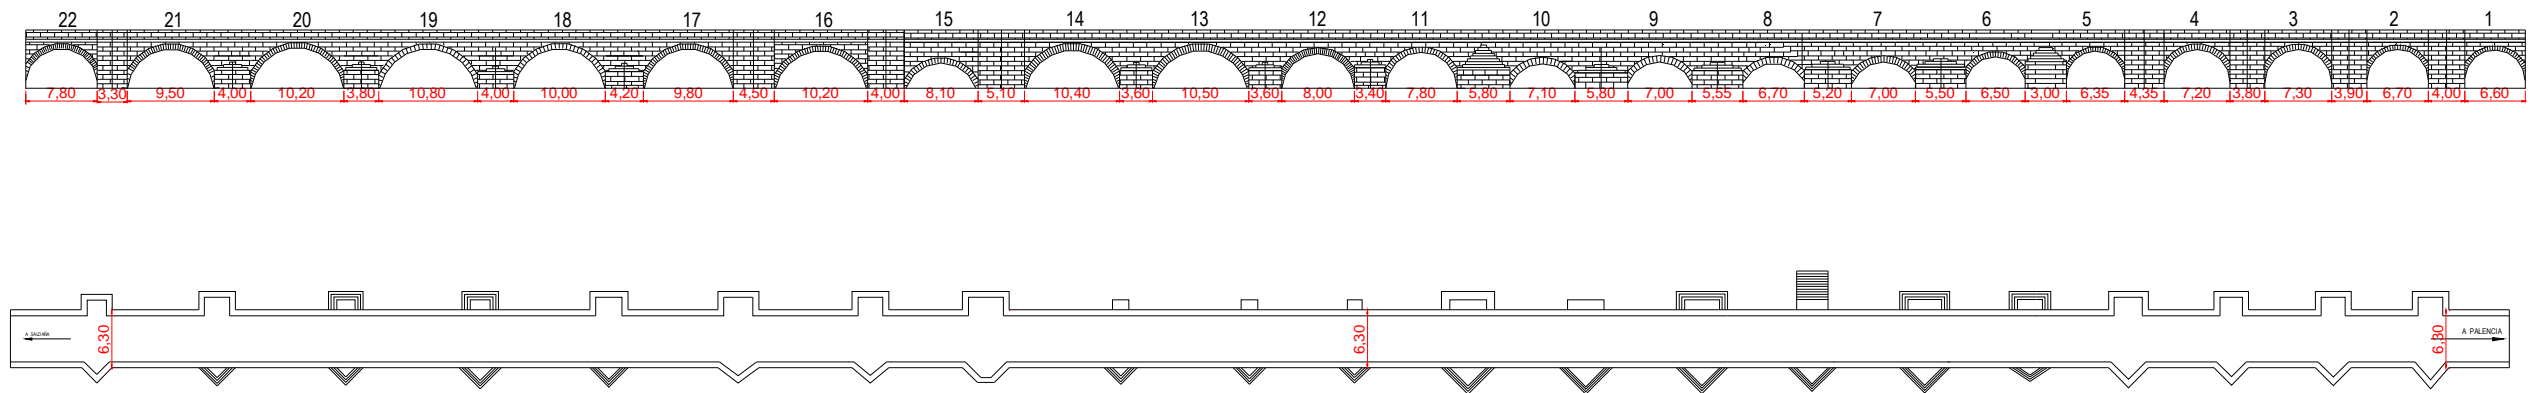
Planta y alzado de aguas arriba del puente en Saldaña
